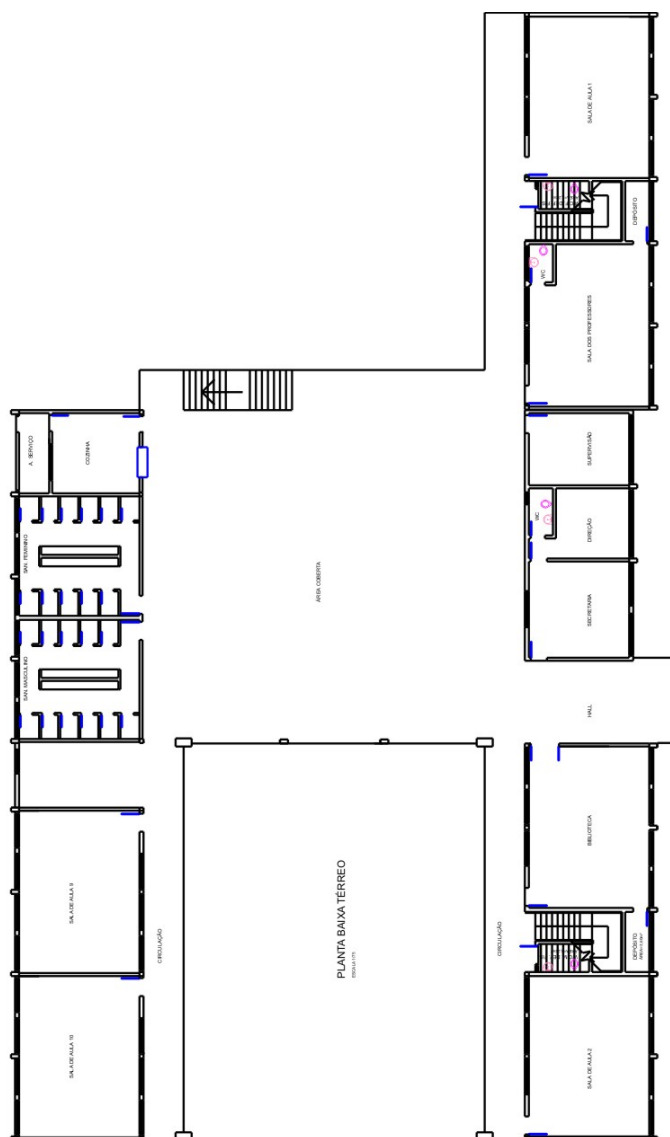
Planta baixa do pavimento térreo Jardim do Lago
